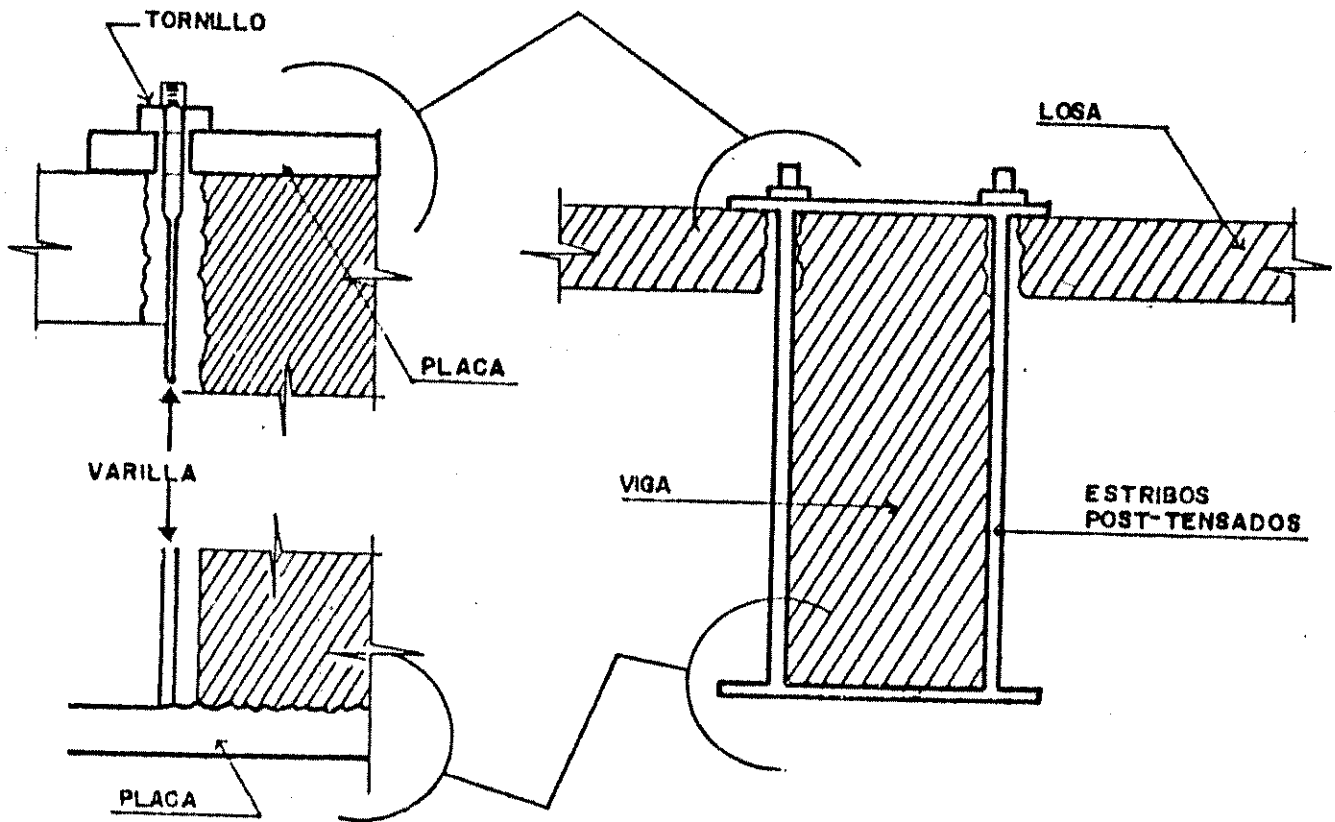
Refuerzo de una viga mediante refuerzo transversal o estribos con varillas pre-tensadas.
